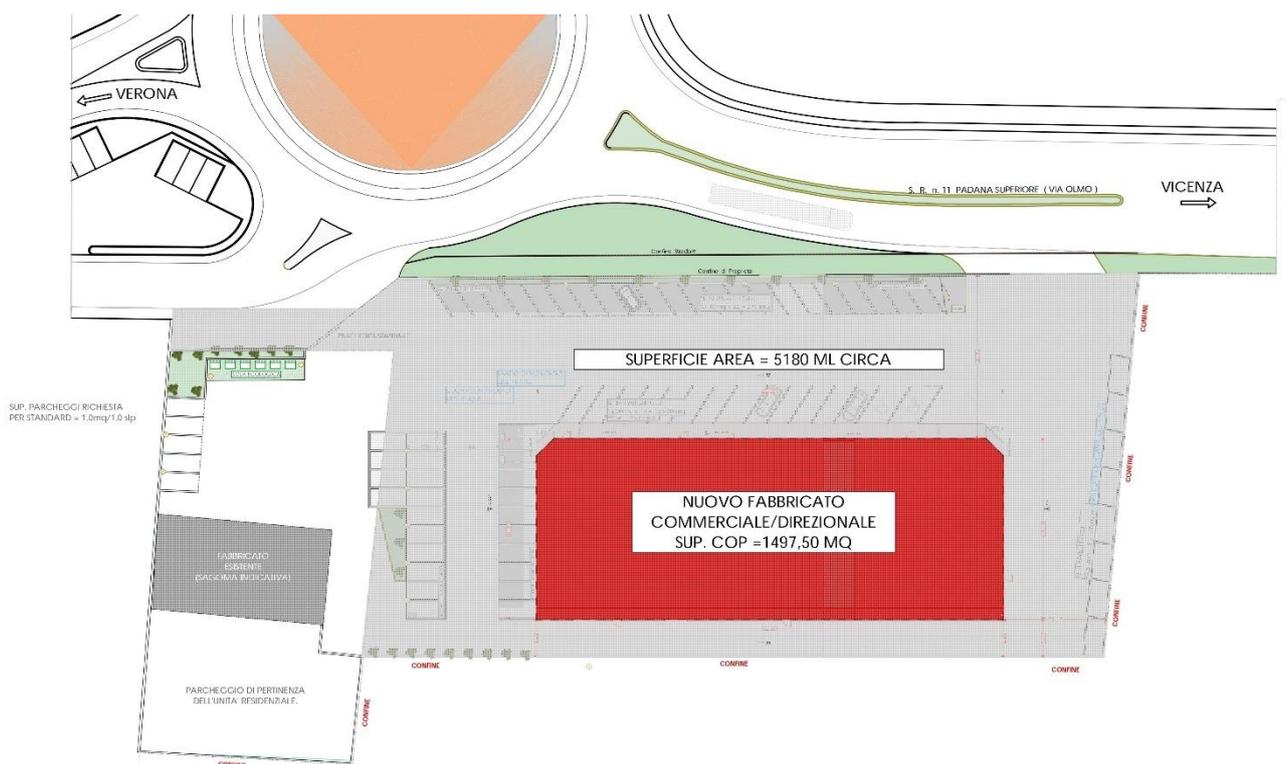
Estratto Tavola 1/4 Inquadramento del progetto
